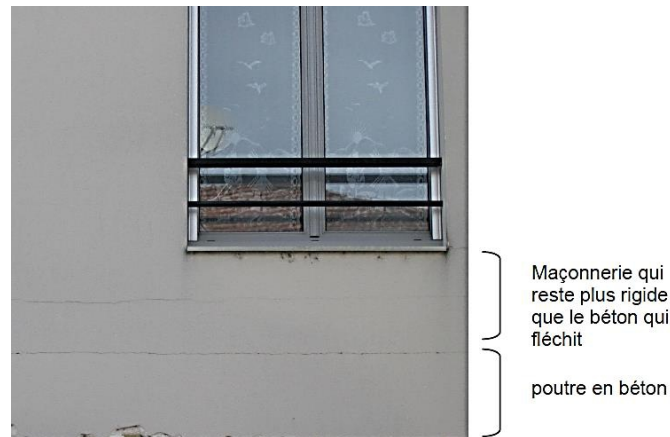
Fissuration liée à la liaison entre béton armé et maçonnerie
